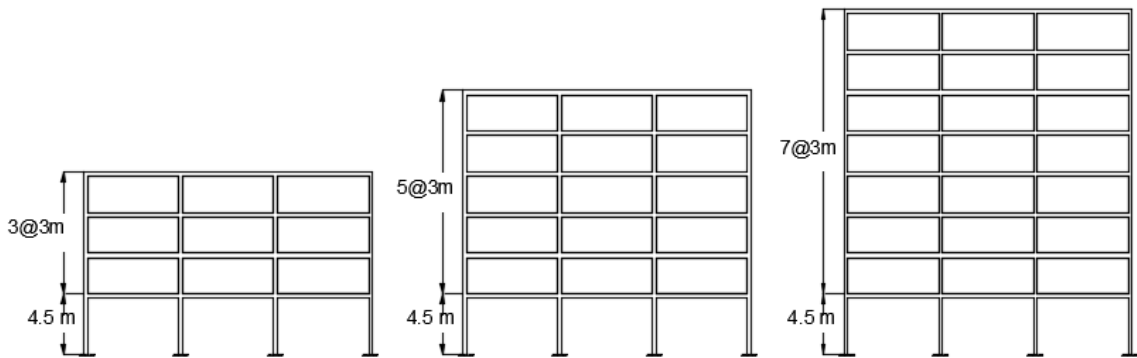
características geométricas en elevación de los edificios de concreto reforzado sin muros ligados
